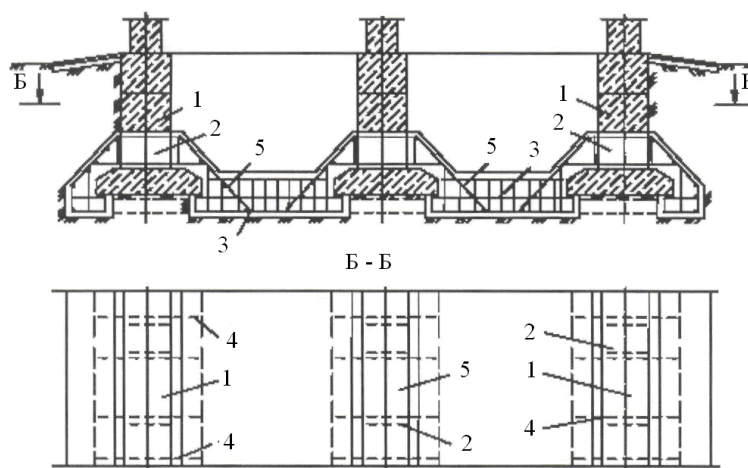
Переоборудование ленточного фундамента в плитный с пробивкой сквозных отверстий в ленточных фундаментах:
